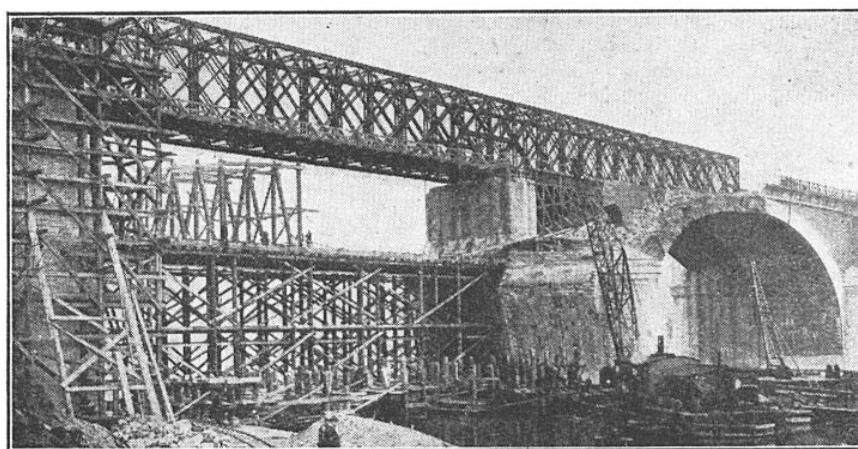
LE PONT DU MÉE (LIGNE PARIS-MARSEILLE) EN RECONSTRUCTION
